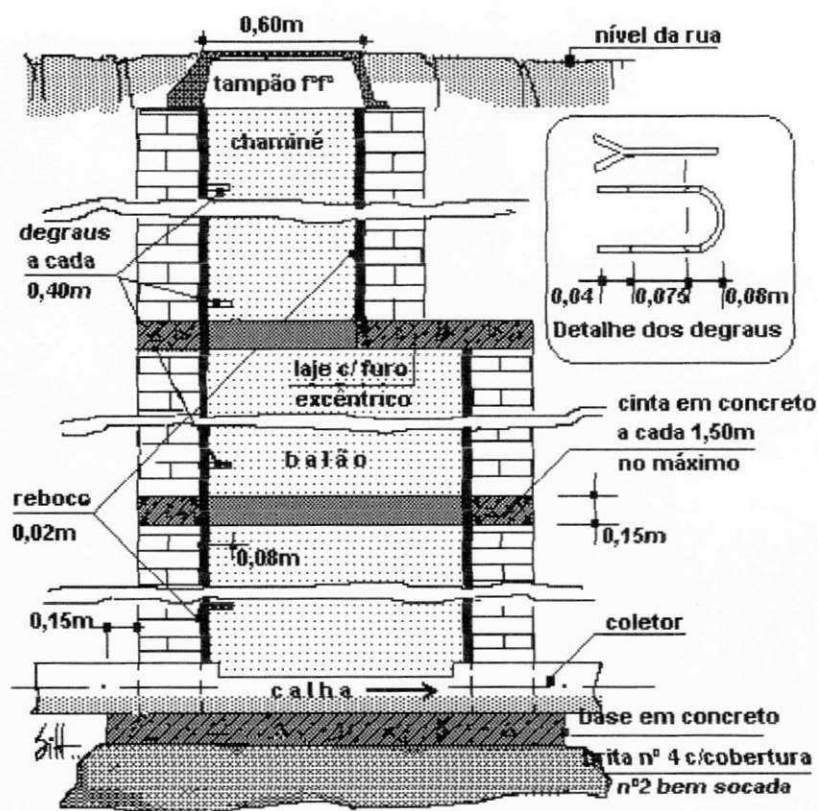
Poço de visita em alvenaria de tijolos
